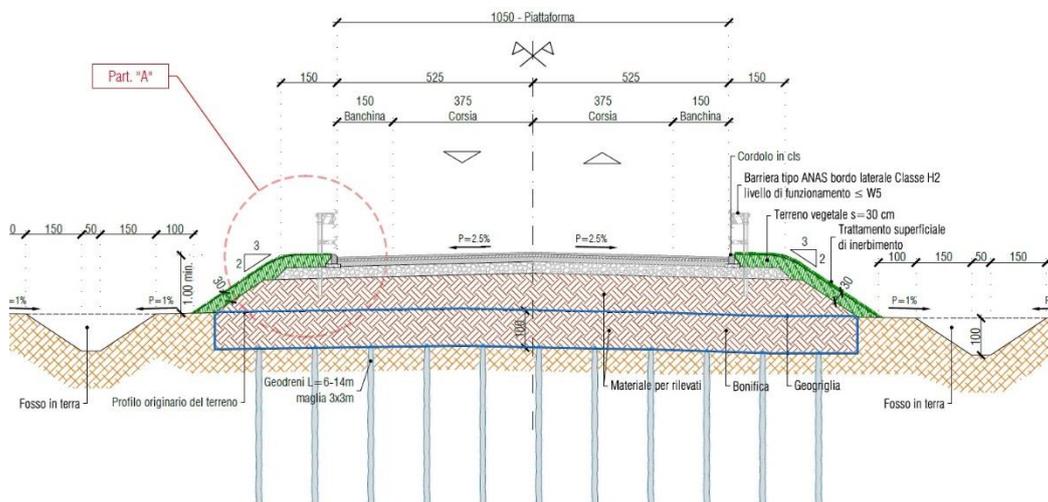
SEZIONE TIPO DI PROGETTO VARIANTE "ARPELLINA"
